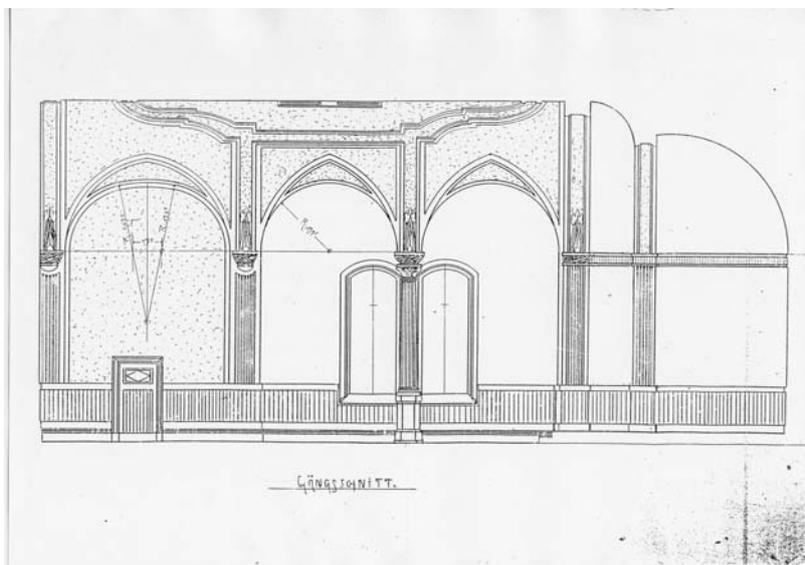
H. Plange, Neanderkirche, Längsschnitt, 1903
